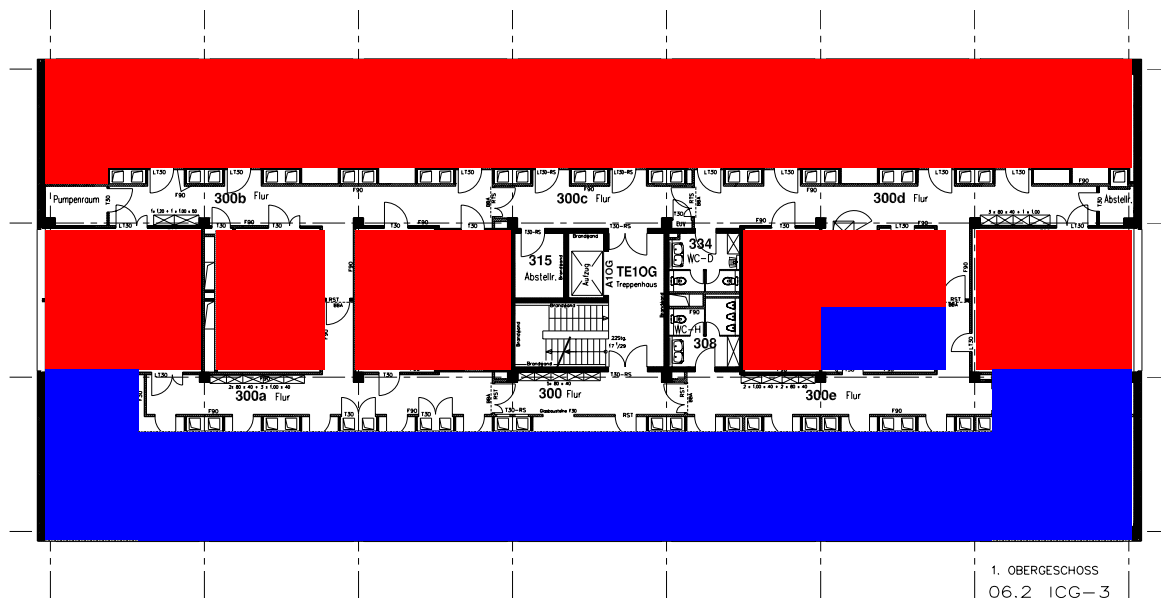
Grundriss des 1. Obergeschosses mit Anordnung von Laborräumen (rot – Nordseite) und Büroräumen (blau – Südseite)
